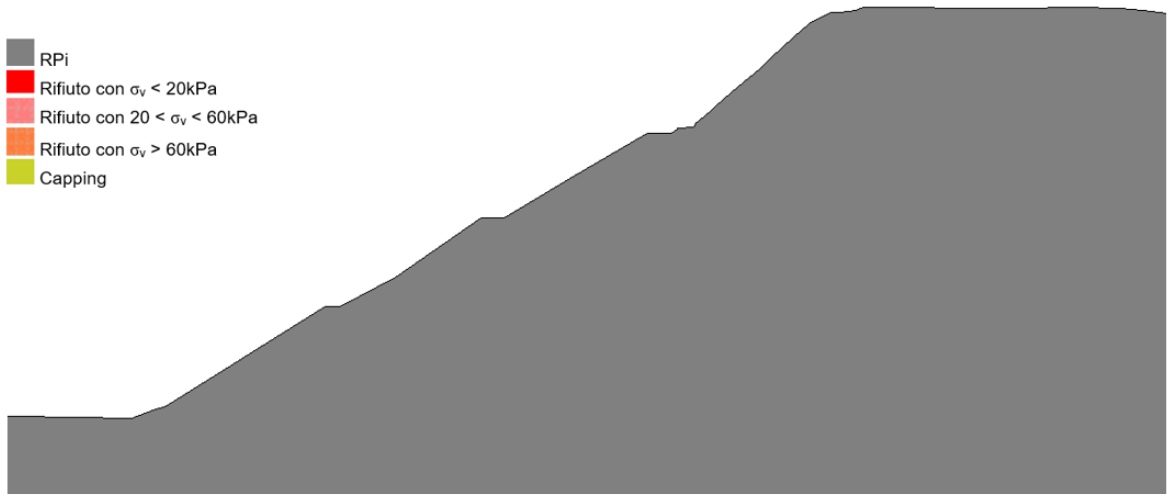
Sezione 4 – Configurazione a scavi aperti
